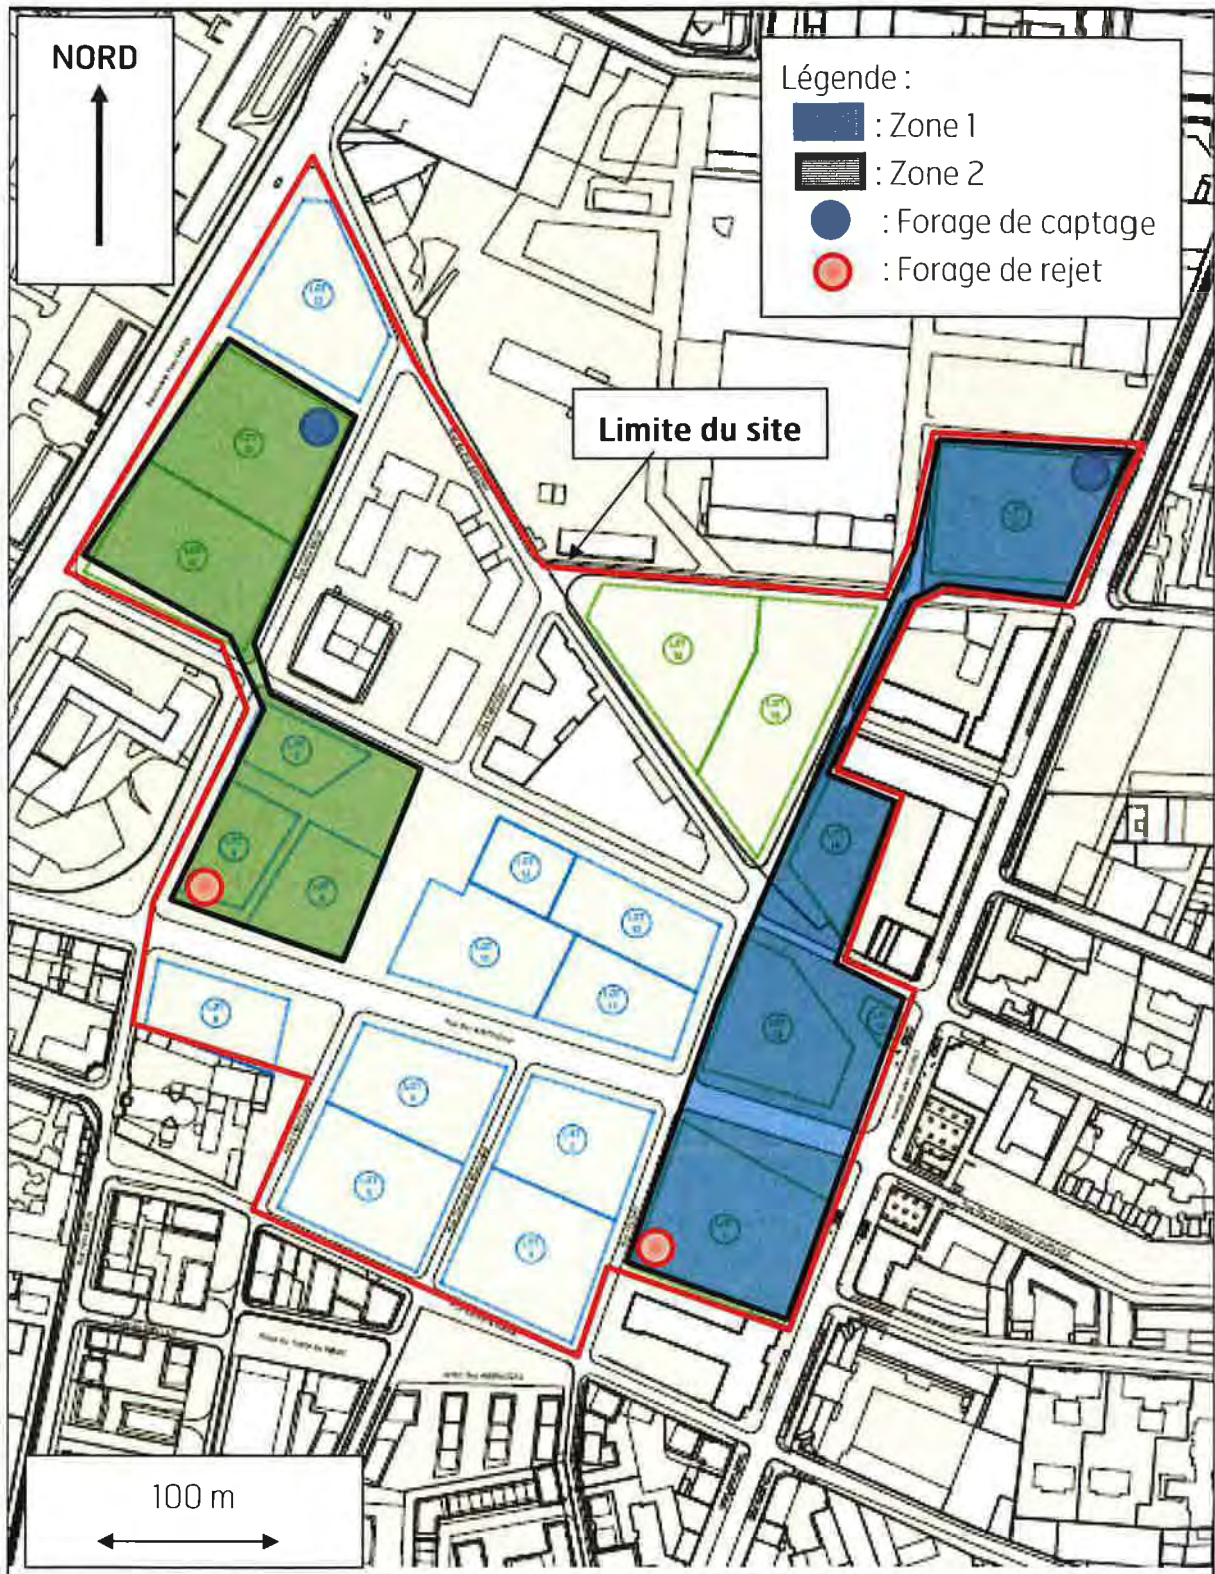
Plans d'implantation prévisionnelle des ouvrages géothermiques : Scénario n°2
